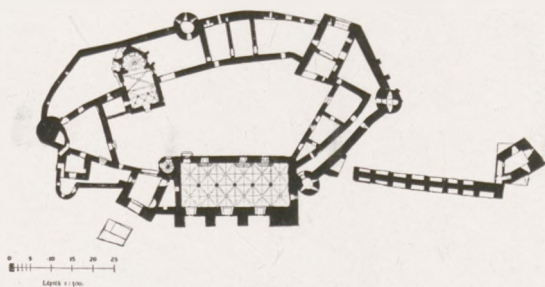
Plan Zamku Vajda Hunyad.¹⁾
